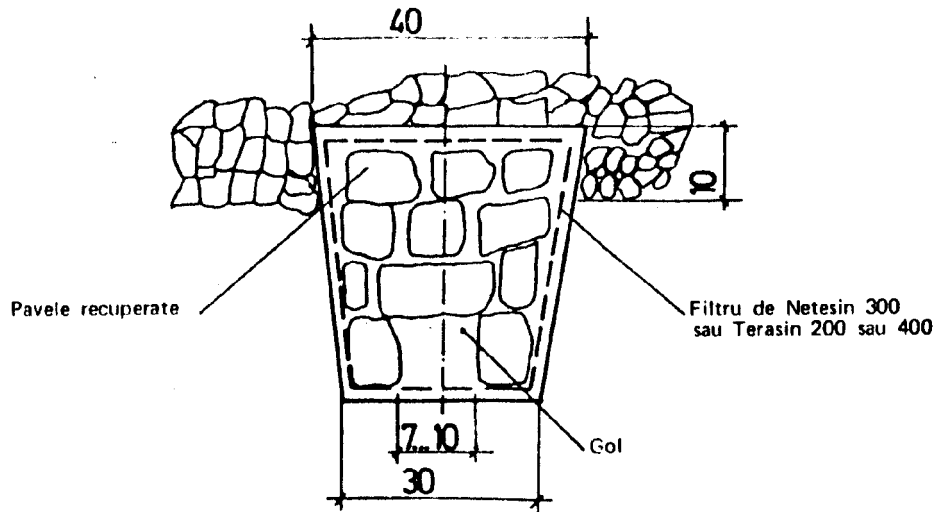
Dren cu corp drenant de pavele recuperate și filtru geotextil
